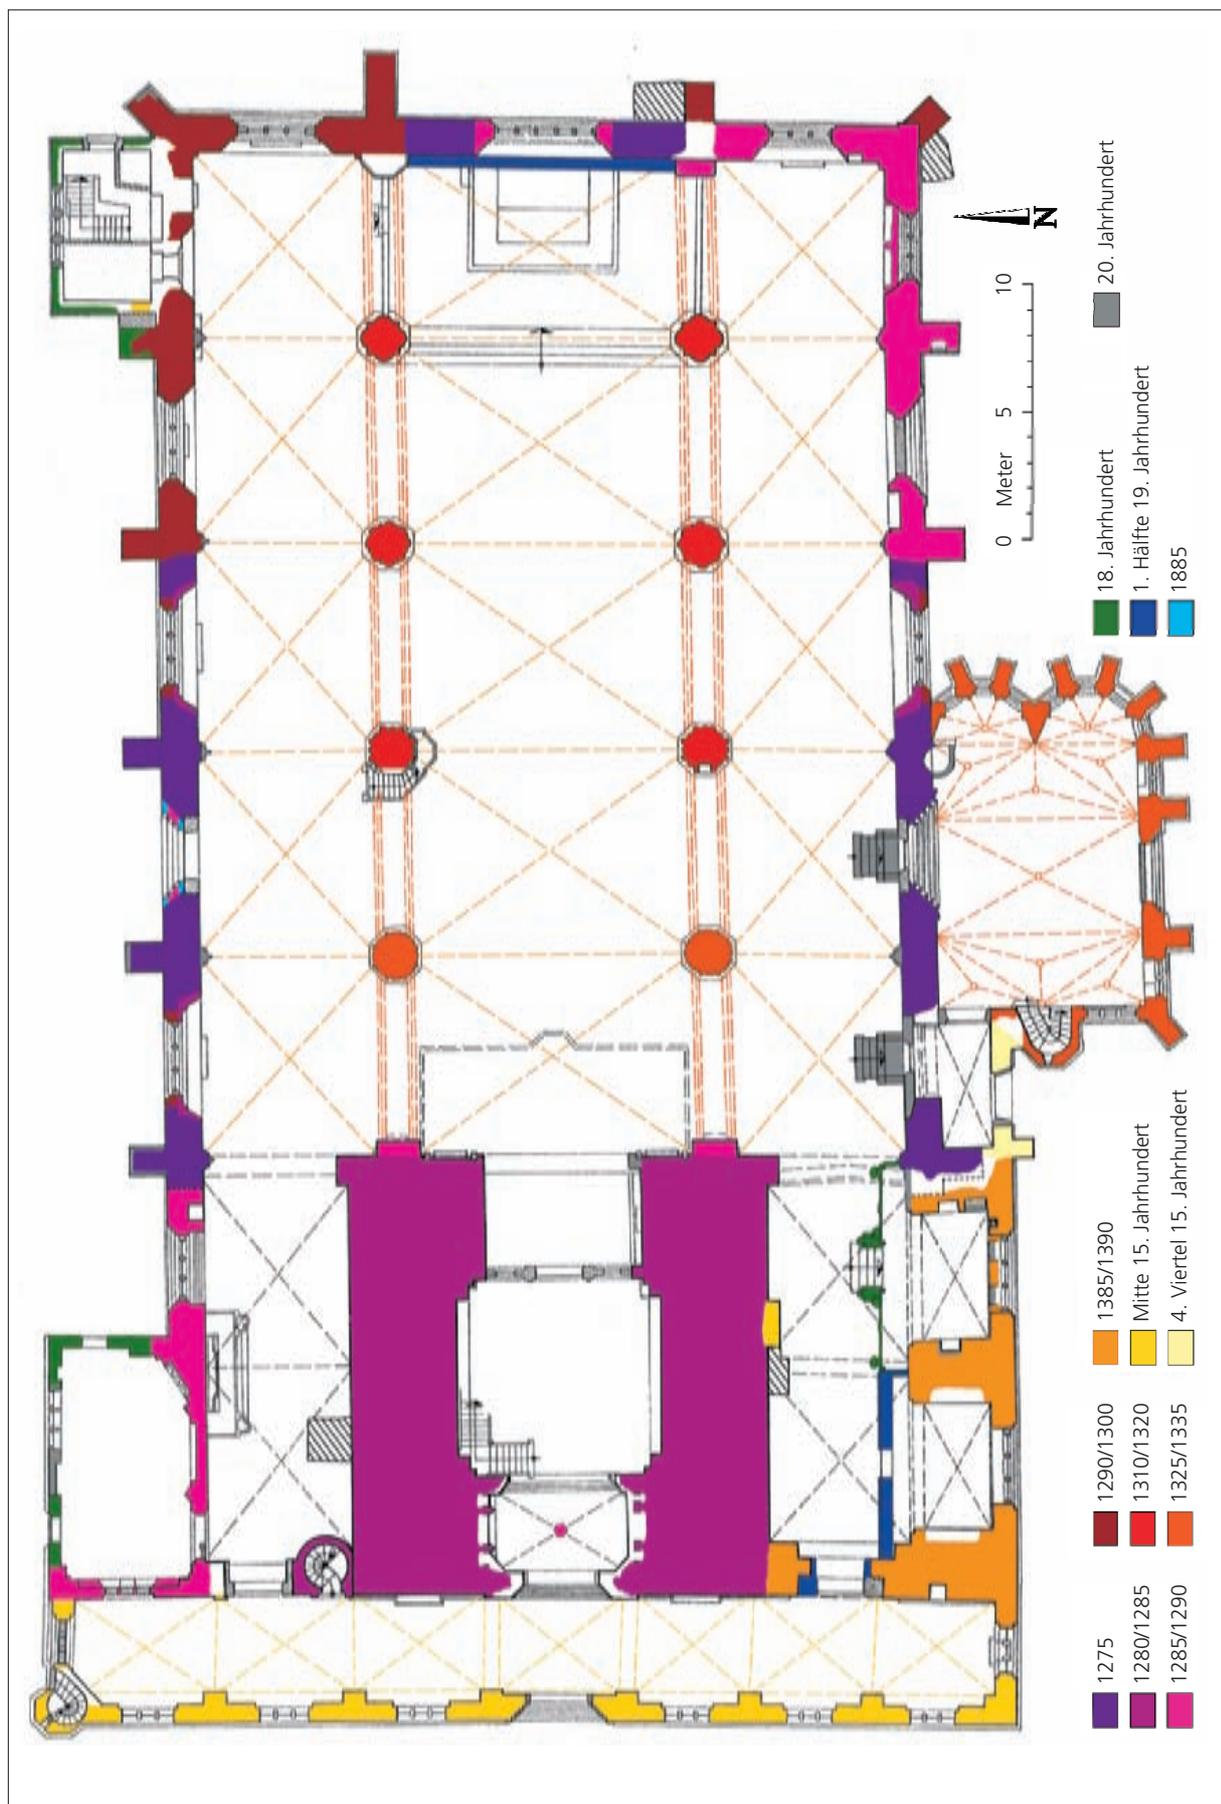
St. Marien, Grundriss mit der Kartierung der wichtigsten Bauphasen
